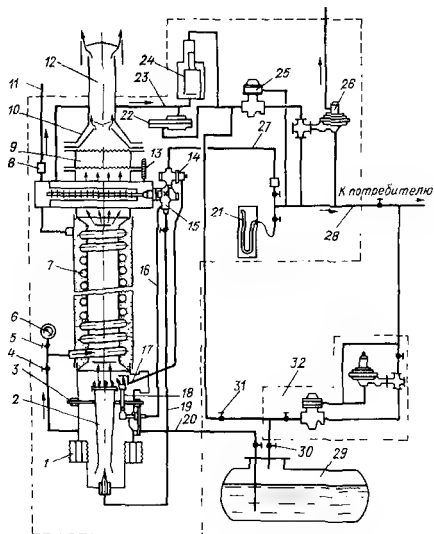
Схема резервуарной установки с испарителем ИГПО-15.
